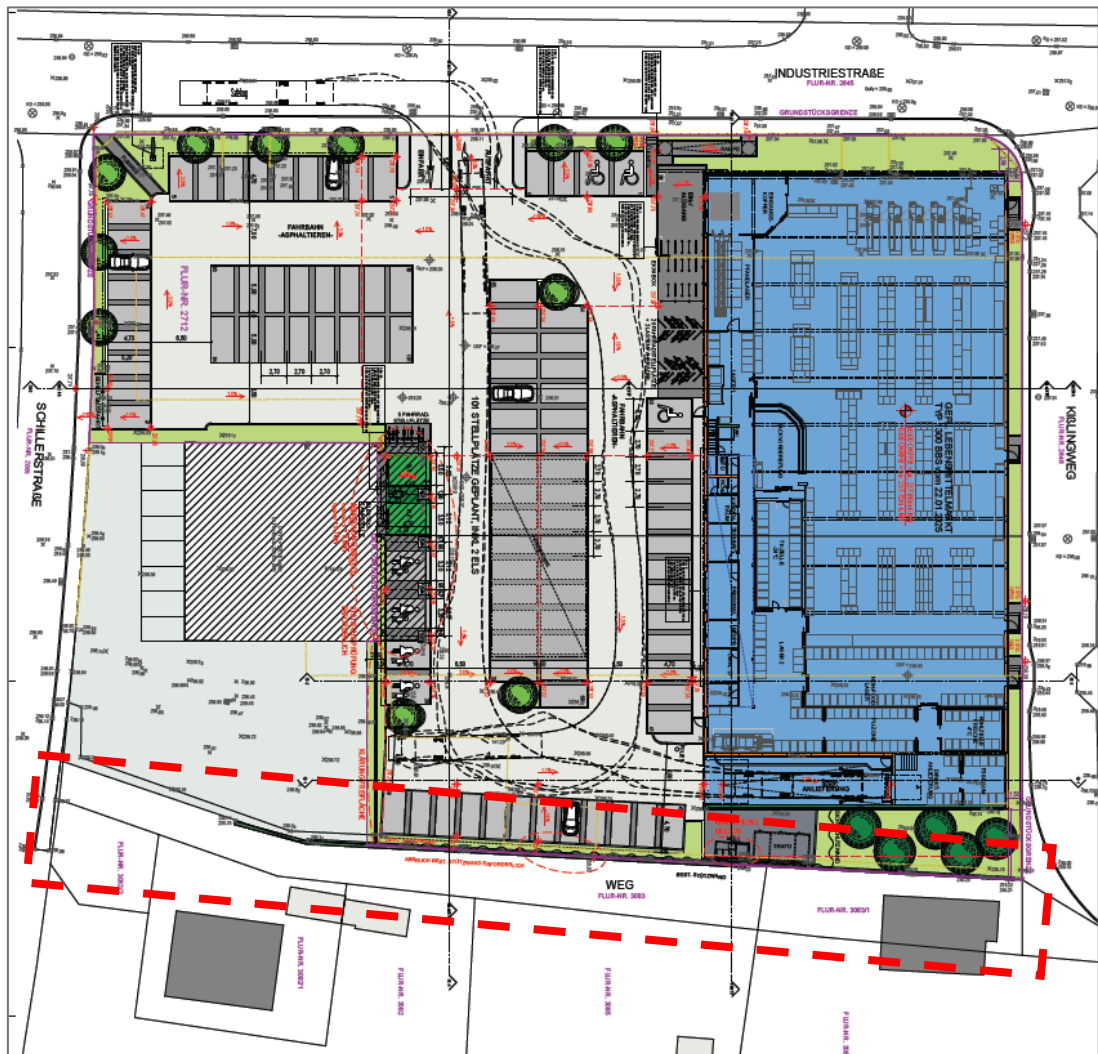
Lageplan des Lebensmittelgeschäftes und Lage des untersuchten Gehölzbestandes (rot gestrichelt)
